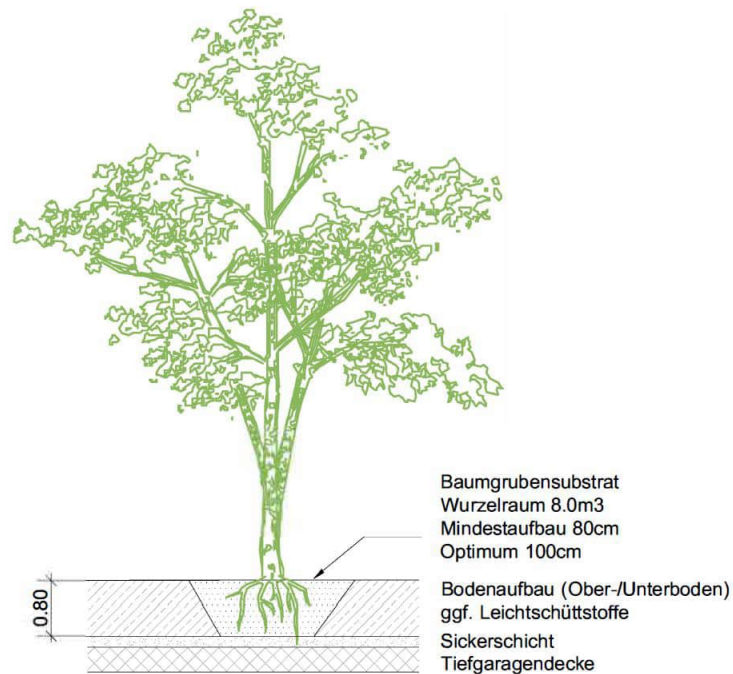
Sicherstellung Durchwurzelungsraum auf unterbauten Baubereichen (Quelle: planikum GmbH, 2020)
